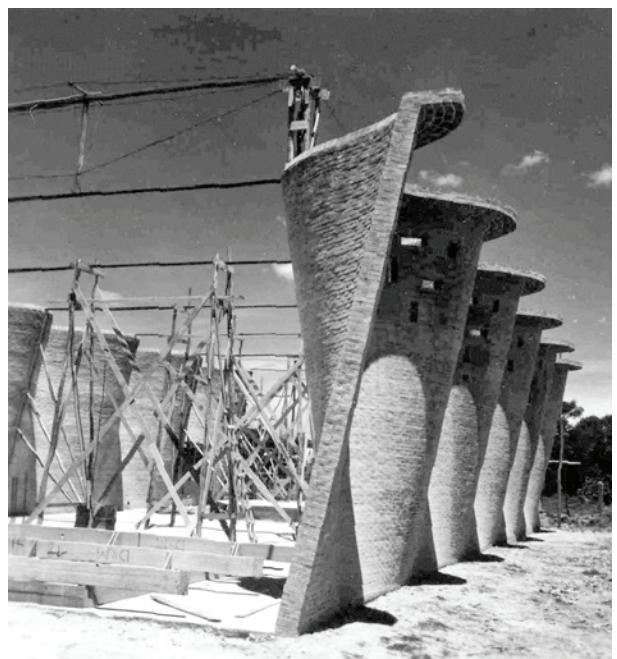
Paredes terminadas em equilíbrio instável, seguradas por andaimes e travessas superiores. No topo, viga horizontal senoidal. (*-6).
